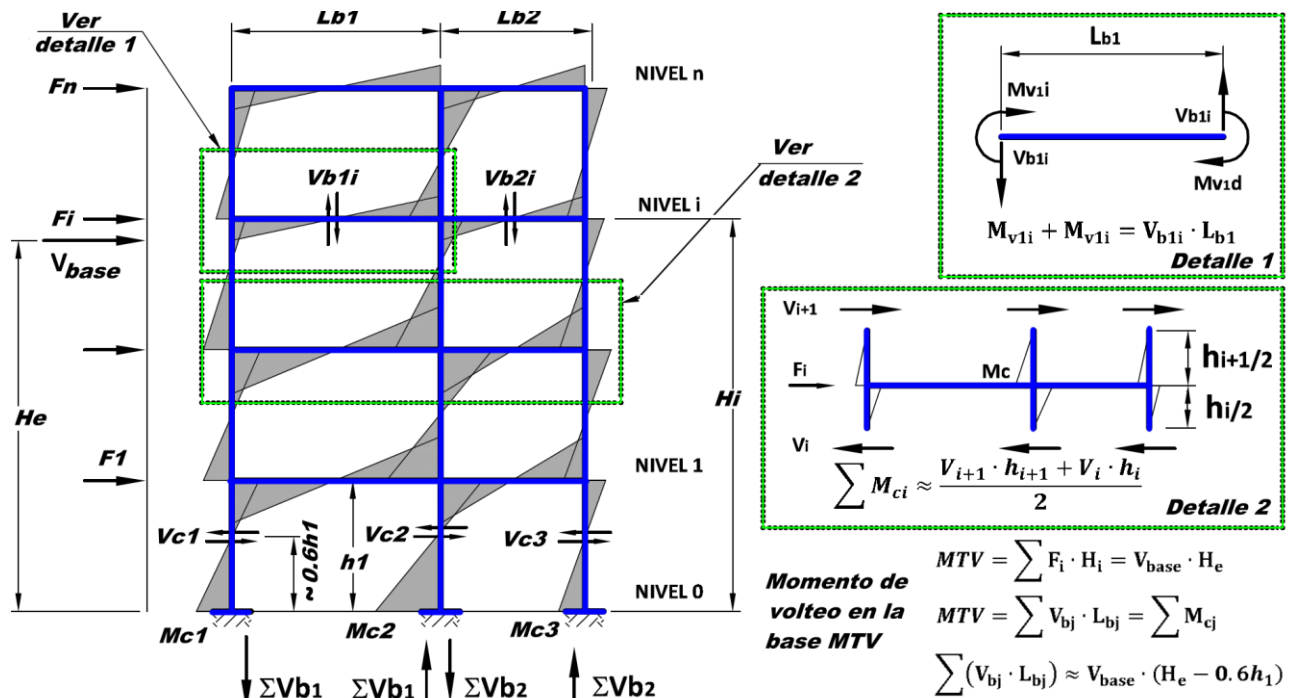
Marco de concreto basado en condiciones de equilibrio.
